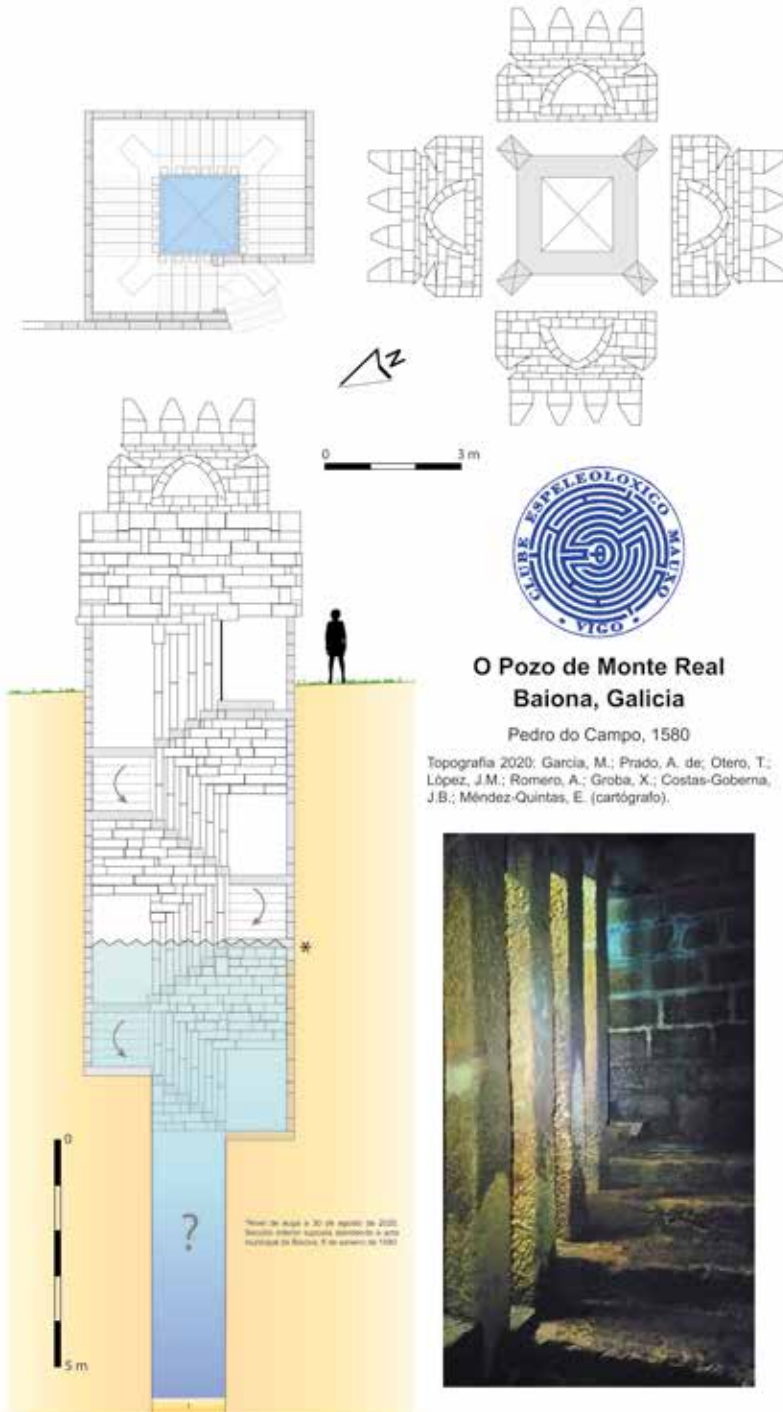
Topografía, planta e alzado do Pozo de Monte Real. Fonte: CEM.
